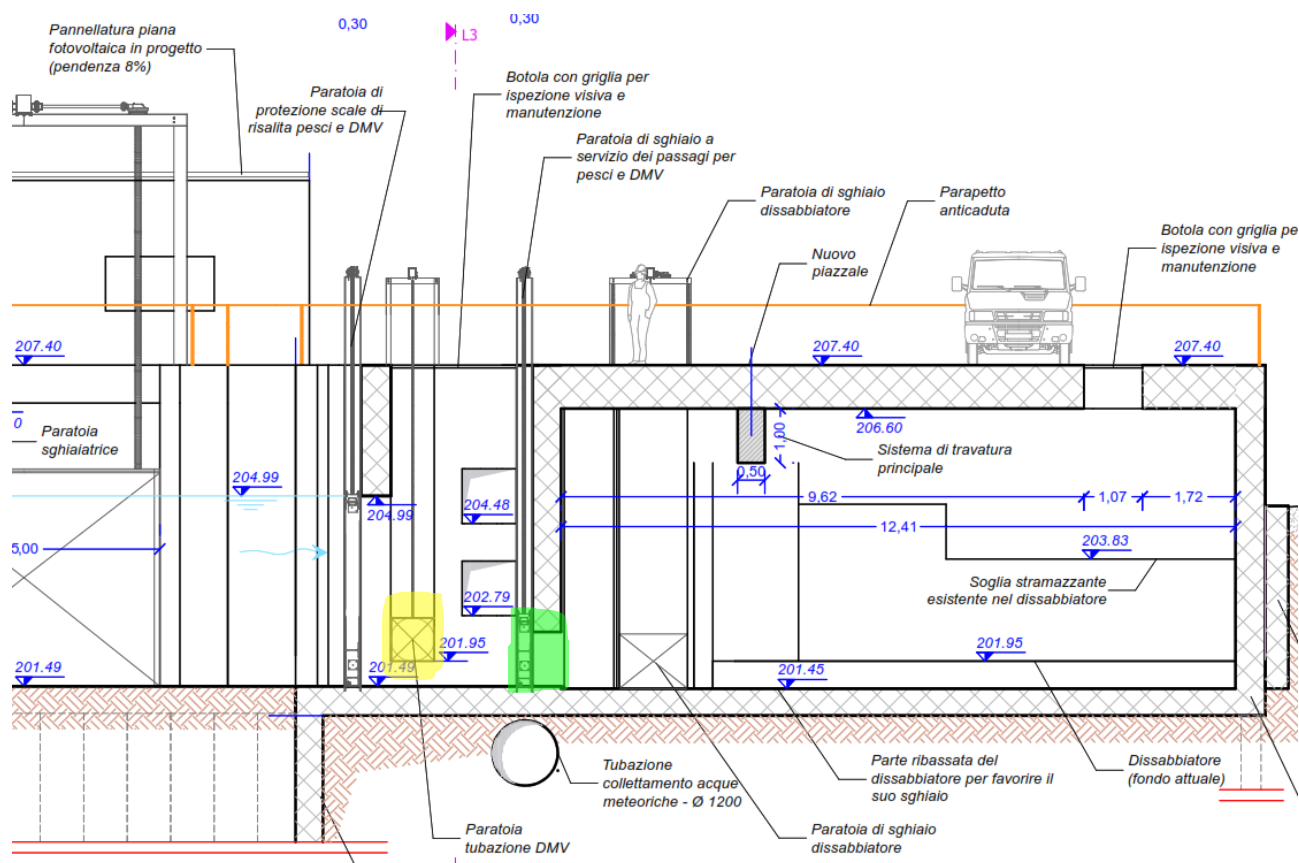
estratto planimetrico di tavola 3.1.4 in cui è stato evidenziato in giallo l'imbocco della tubazione di rilascio mentre in verde la luce di sghiaio e pulizia di fondo pozzetto
